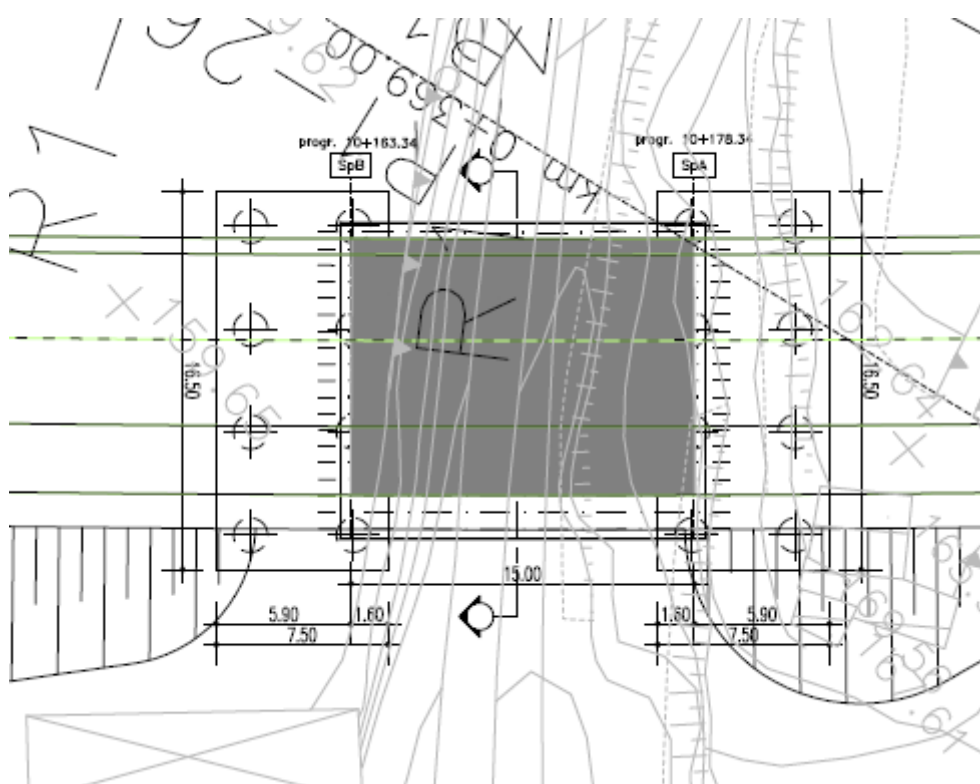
Planimetria viadotto svincolo Annunziata direzione Reggio Calabria.
